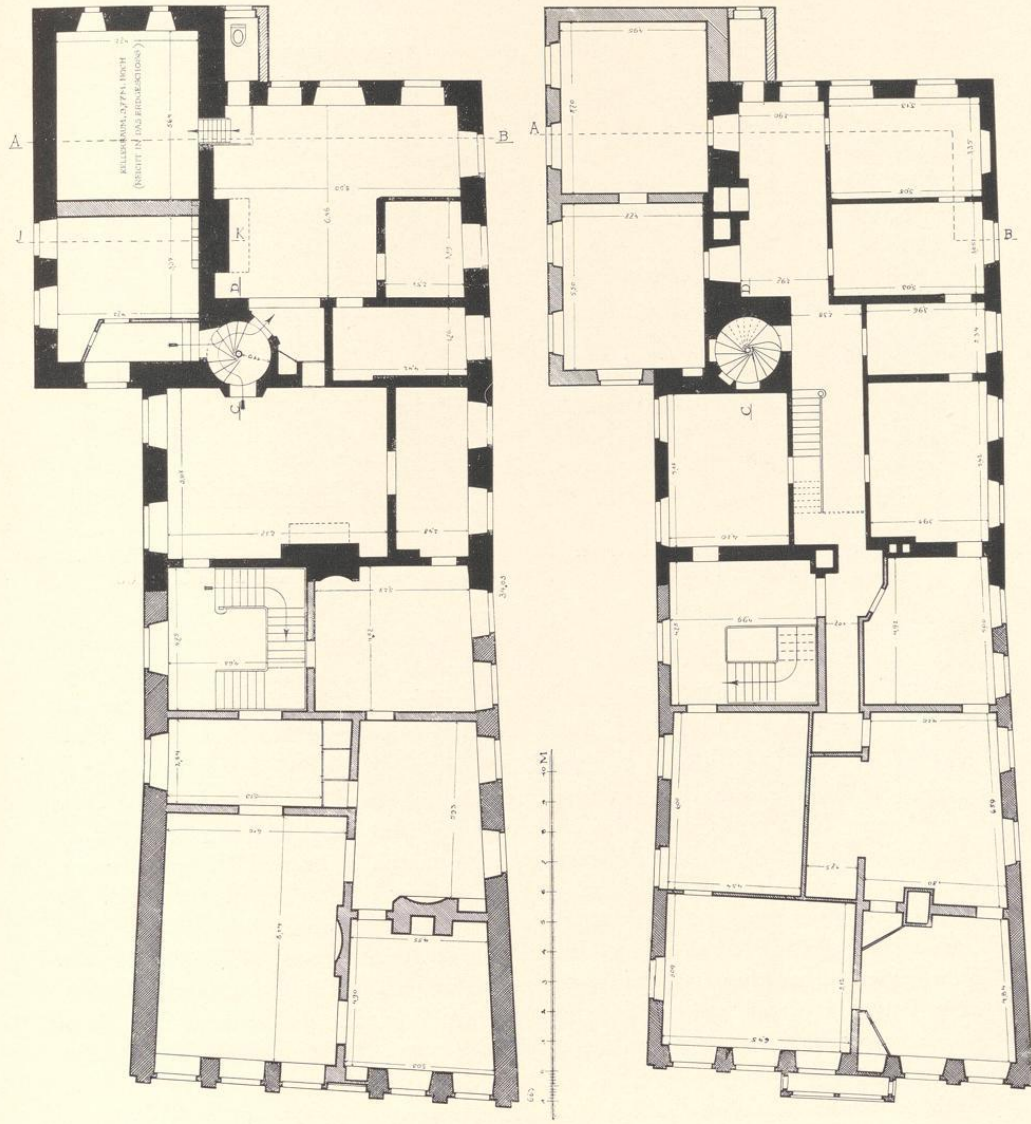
und 739. Grundrisse des Erd- und Obergeschosses des Hofes Königstraße 47. Norden unten; Maßstab 1 : 200
